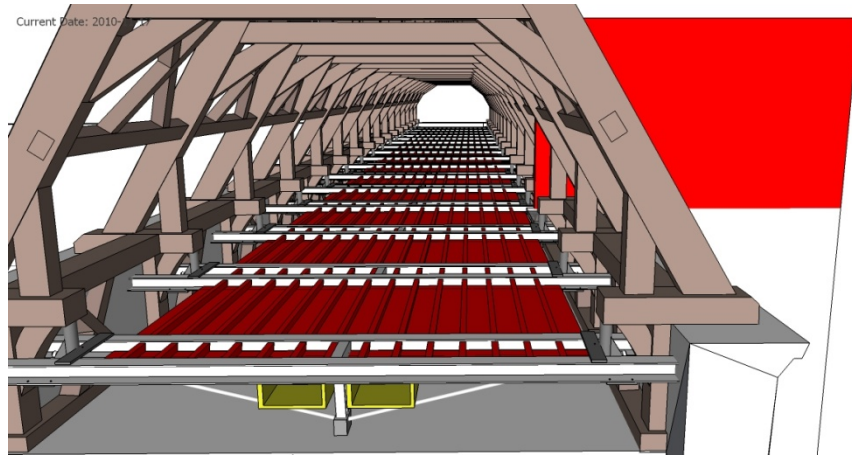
Mise en place des tôles de coffrage perdu de la dalle et la construction en parallèle de la dernière partie de la tourelle d'escalier en béton.
